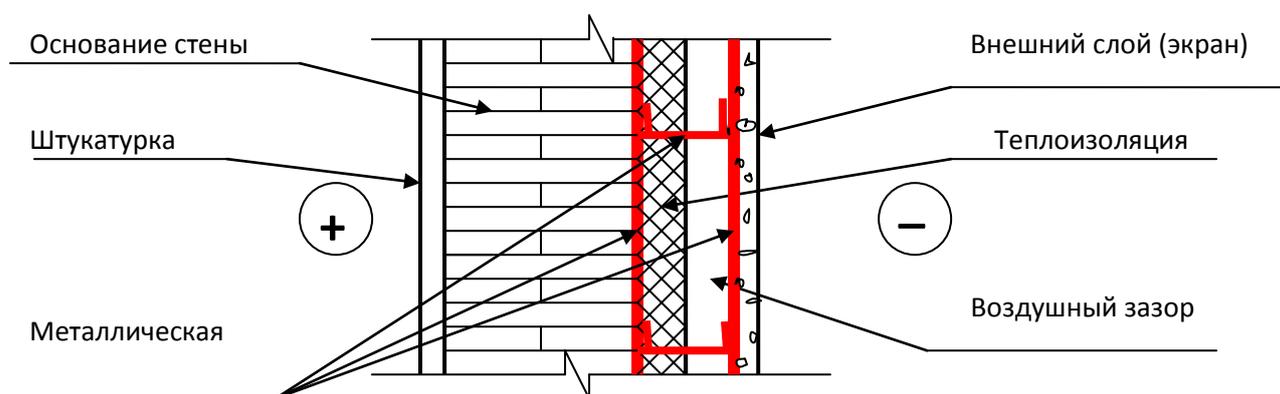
Конструкция фасадной системы с вентилируемым воздушным зазором
